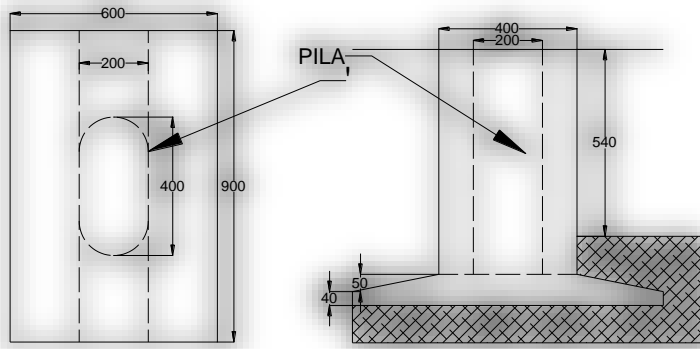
Planta y elevación de zapatas y pilas, cotas en cm. (G.E.M., 1992).
